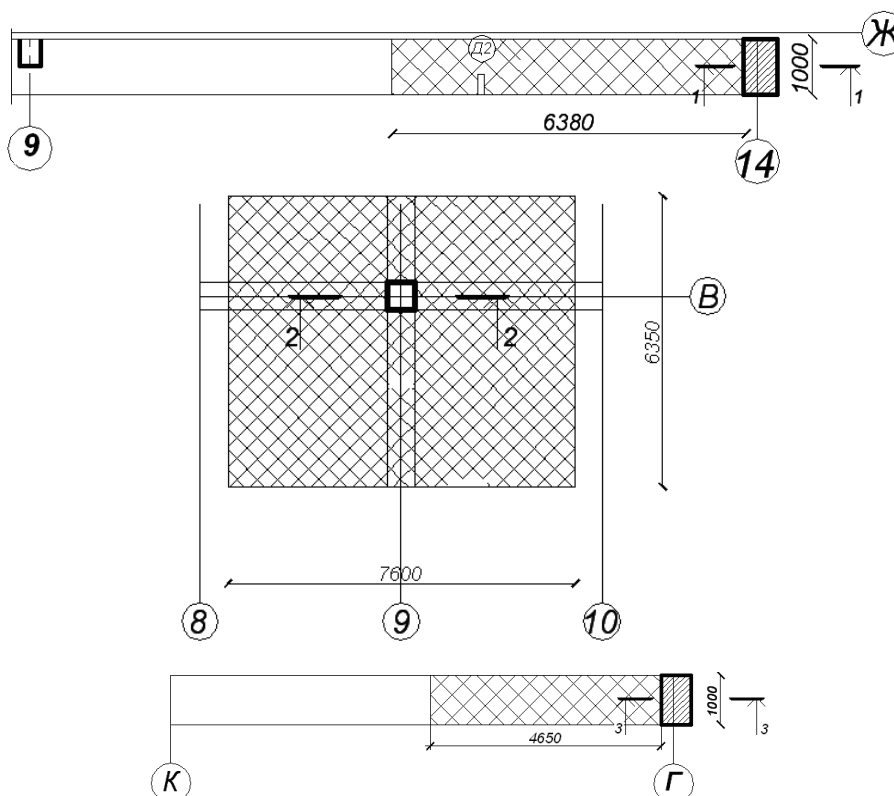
Площа розподілу навантажень на фундамент
